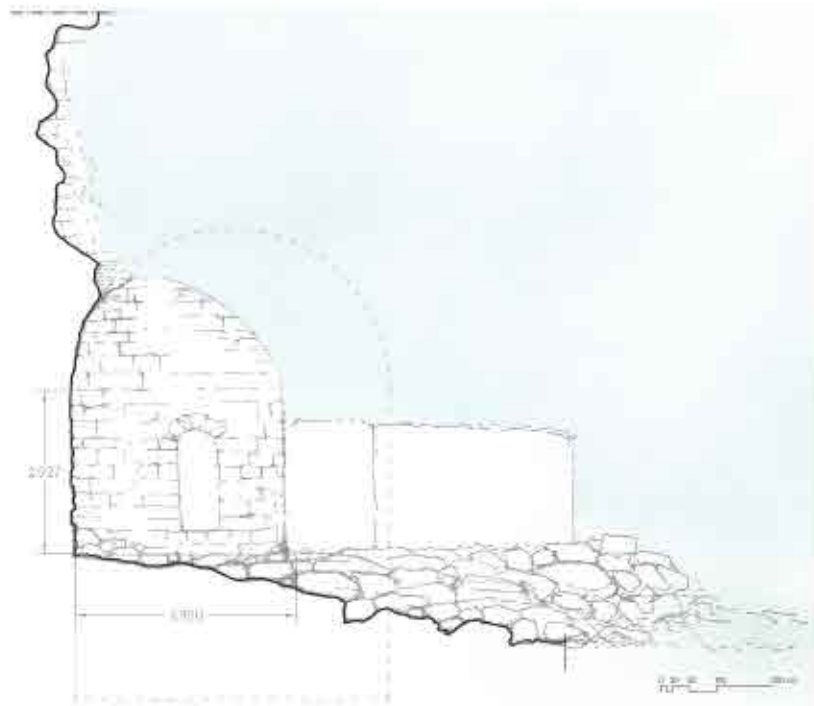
Rilievo: sezione dei resti delle gallerie.; *Survey: section of the ruins of tunnels
